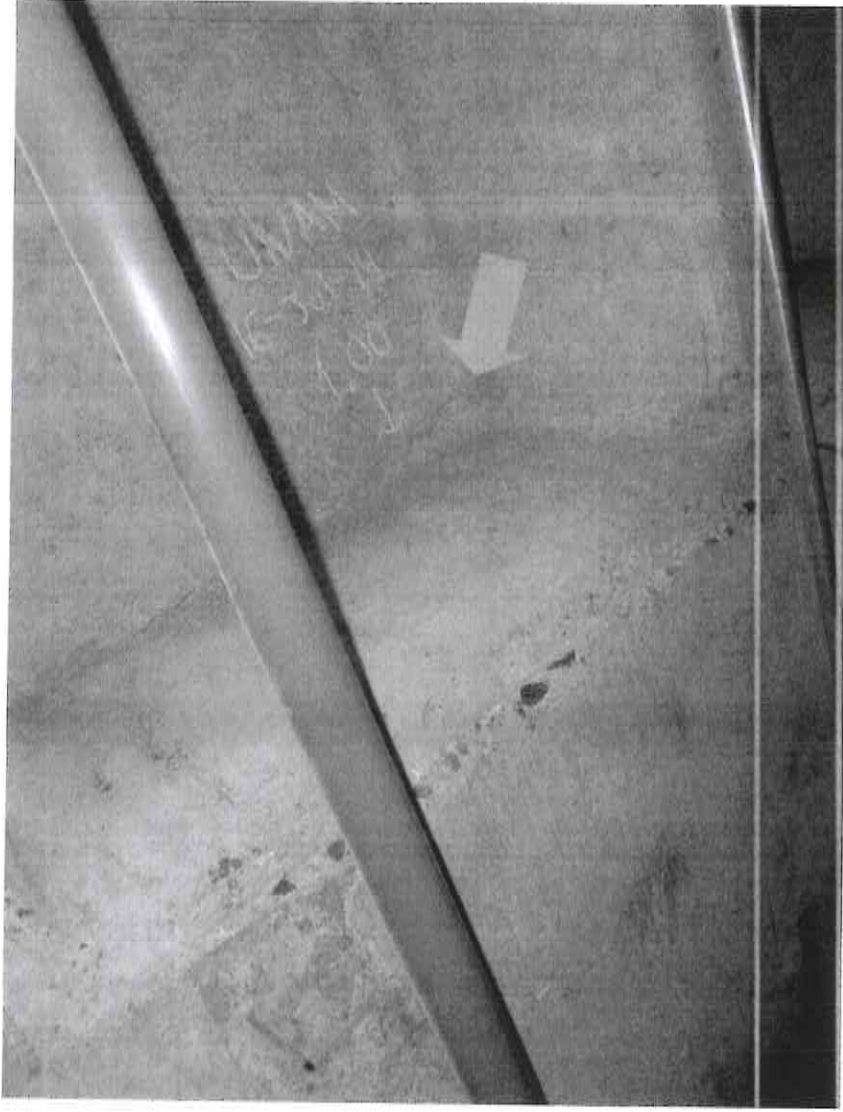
Nivel 8 Revisión de columnas. No presentan daño estructural.
